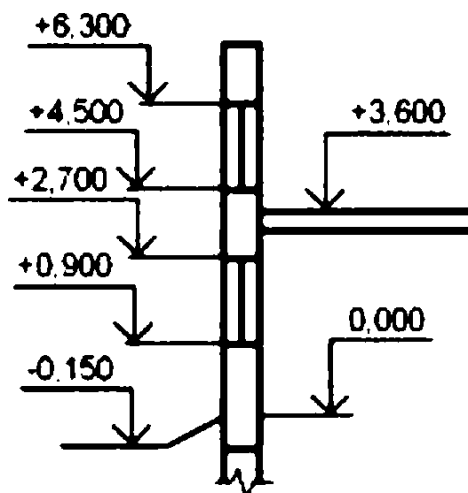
Отметки уровней на фасадах, разрезах и сечениях
